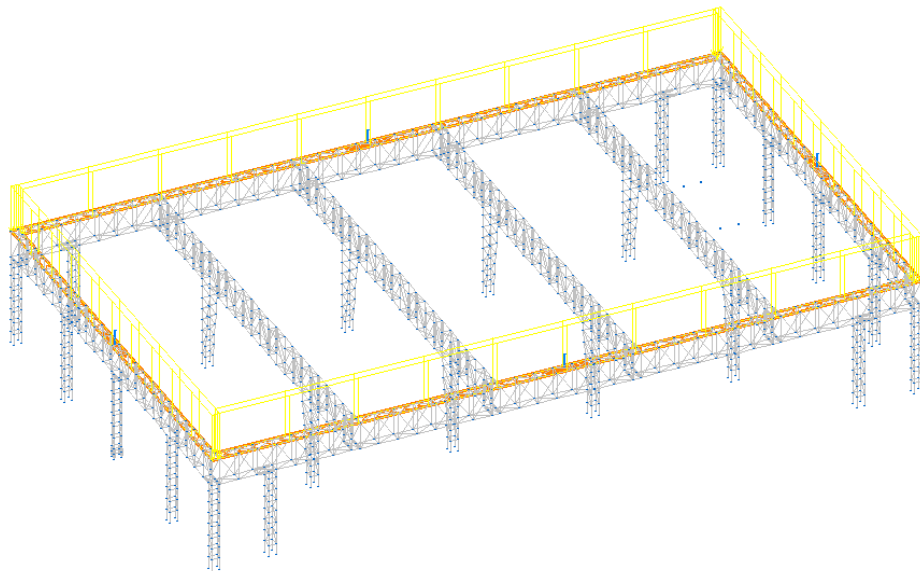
| Detalle de aplicación de carga sobre vigas perimetrales
